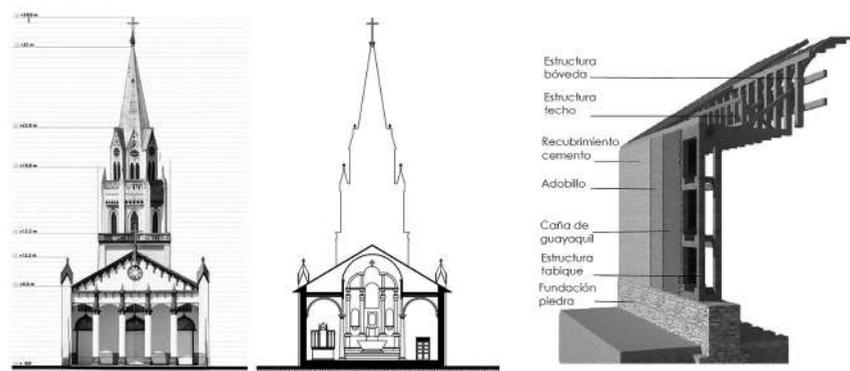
Fotogrametría de la elevación norte, corte transversal y detalle constructivo de los muros estructurales de entramados de madera de la Iglesia San Vicente de Paul en Caldera (Alegría et al., 2008).
